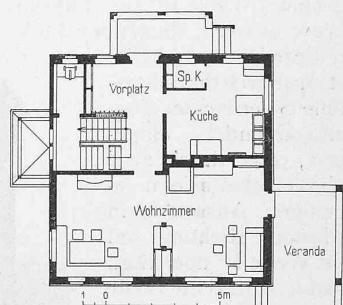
Grundriss vom Erdgeschoss des Hauses von Dr. Finckh. — 1:400.
